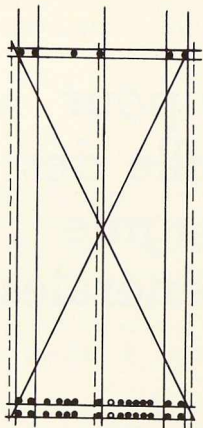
Coupe A-B dans une des poutres d'étaisonnement (voir fig. 5).
